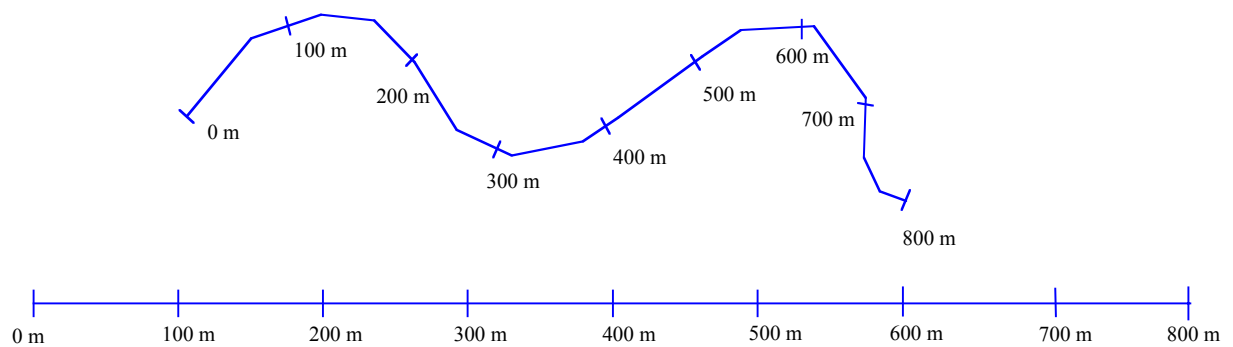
Aufspannung (GRUNDRISS)
